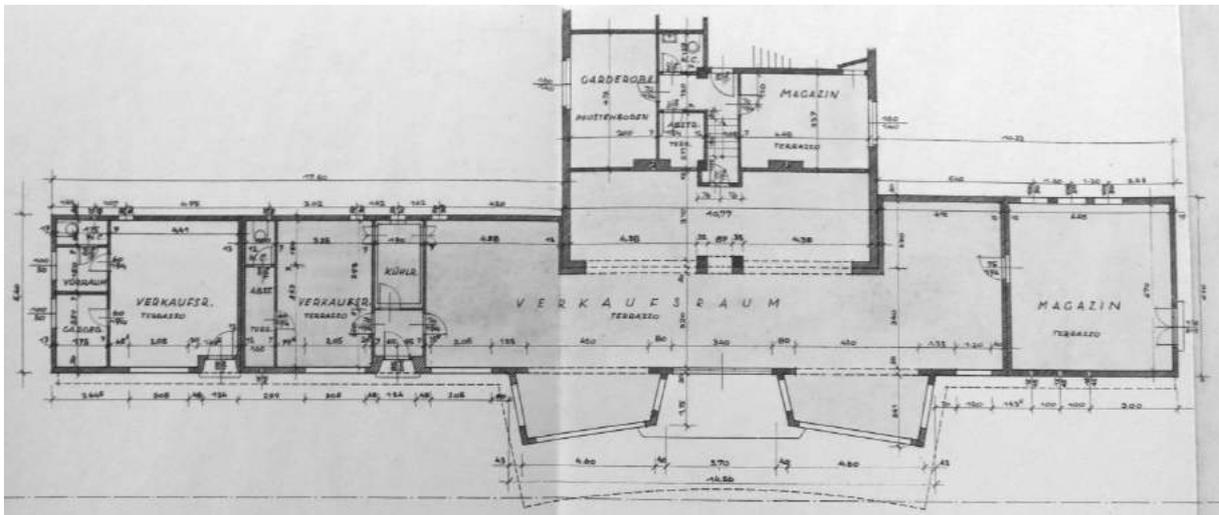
Grundriss Nahversorger/Konsum
